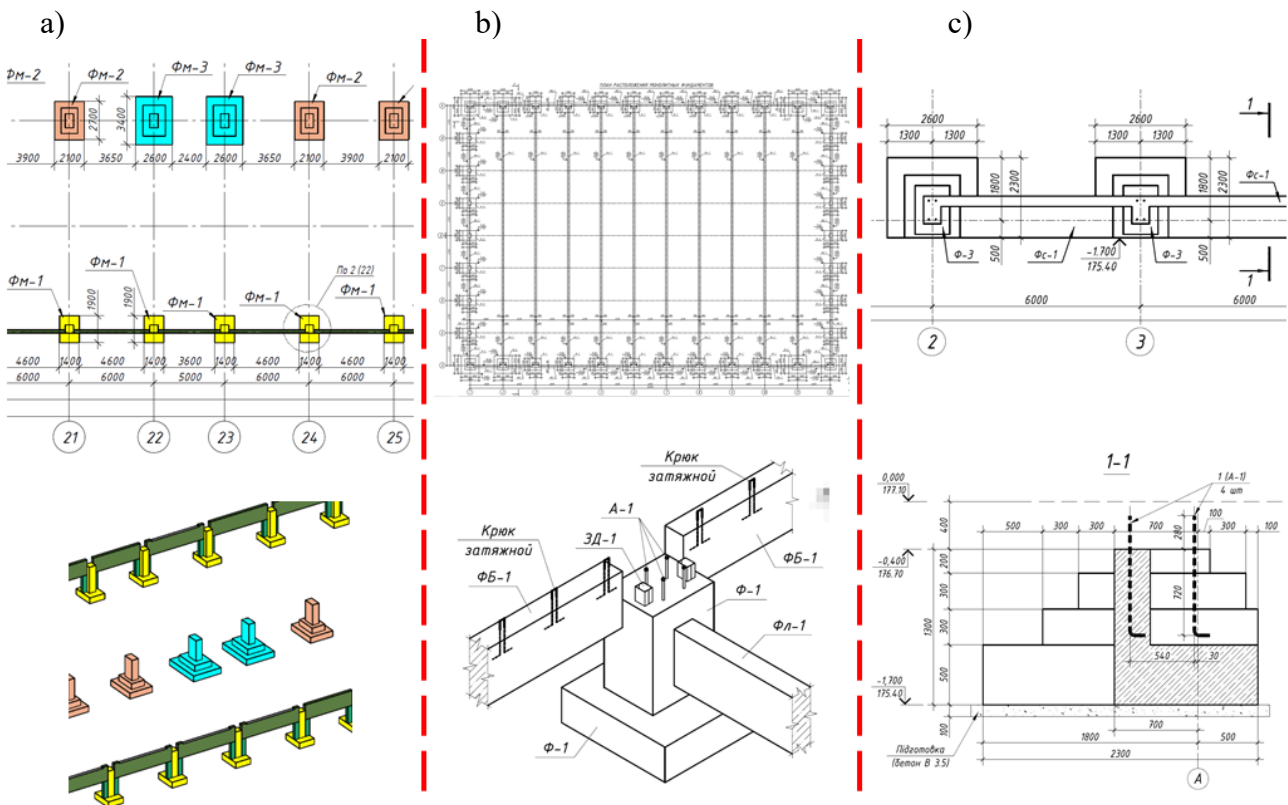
Способи конструювання фундаментів для погашення відриву підосви фундаментів: a) розвиток розмірів підосви в плані; b) влаштування затяжок; c) влаштування упорів або розпірок.
